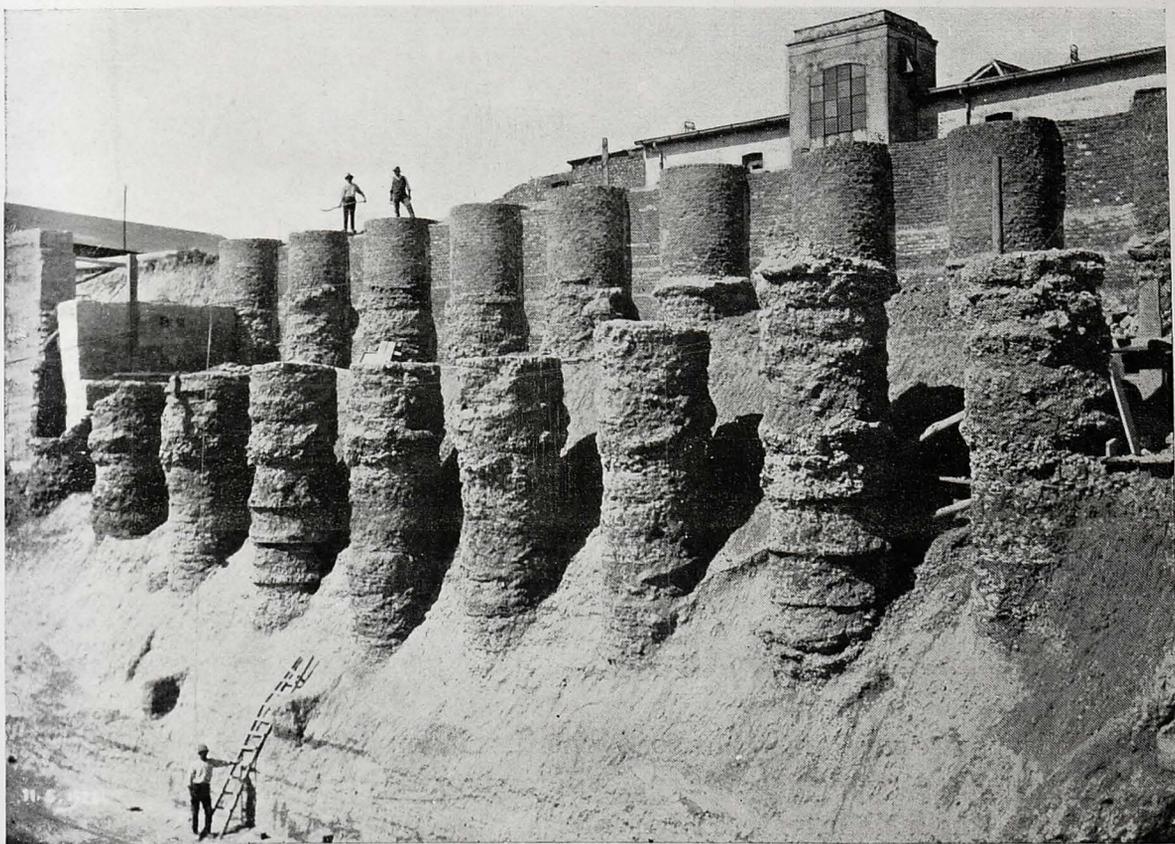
SCAVO DI FONDAZIONE DELLA CENTRALE
